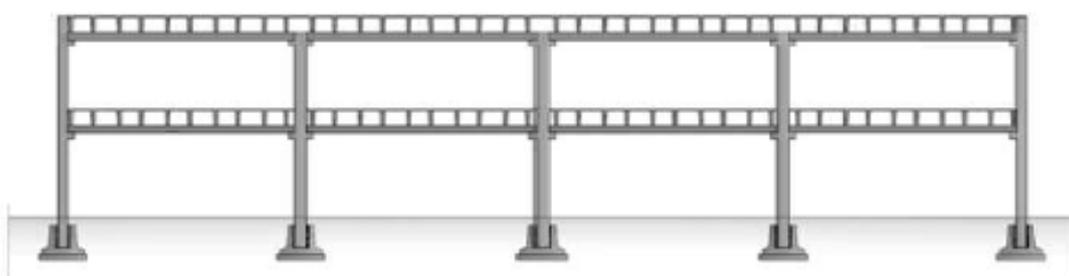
Esempio di edificio prefabbricato pluripiano senza controventi
